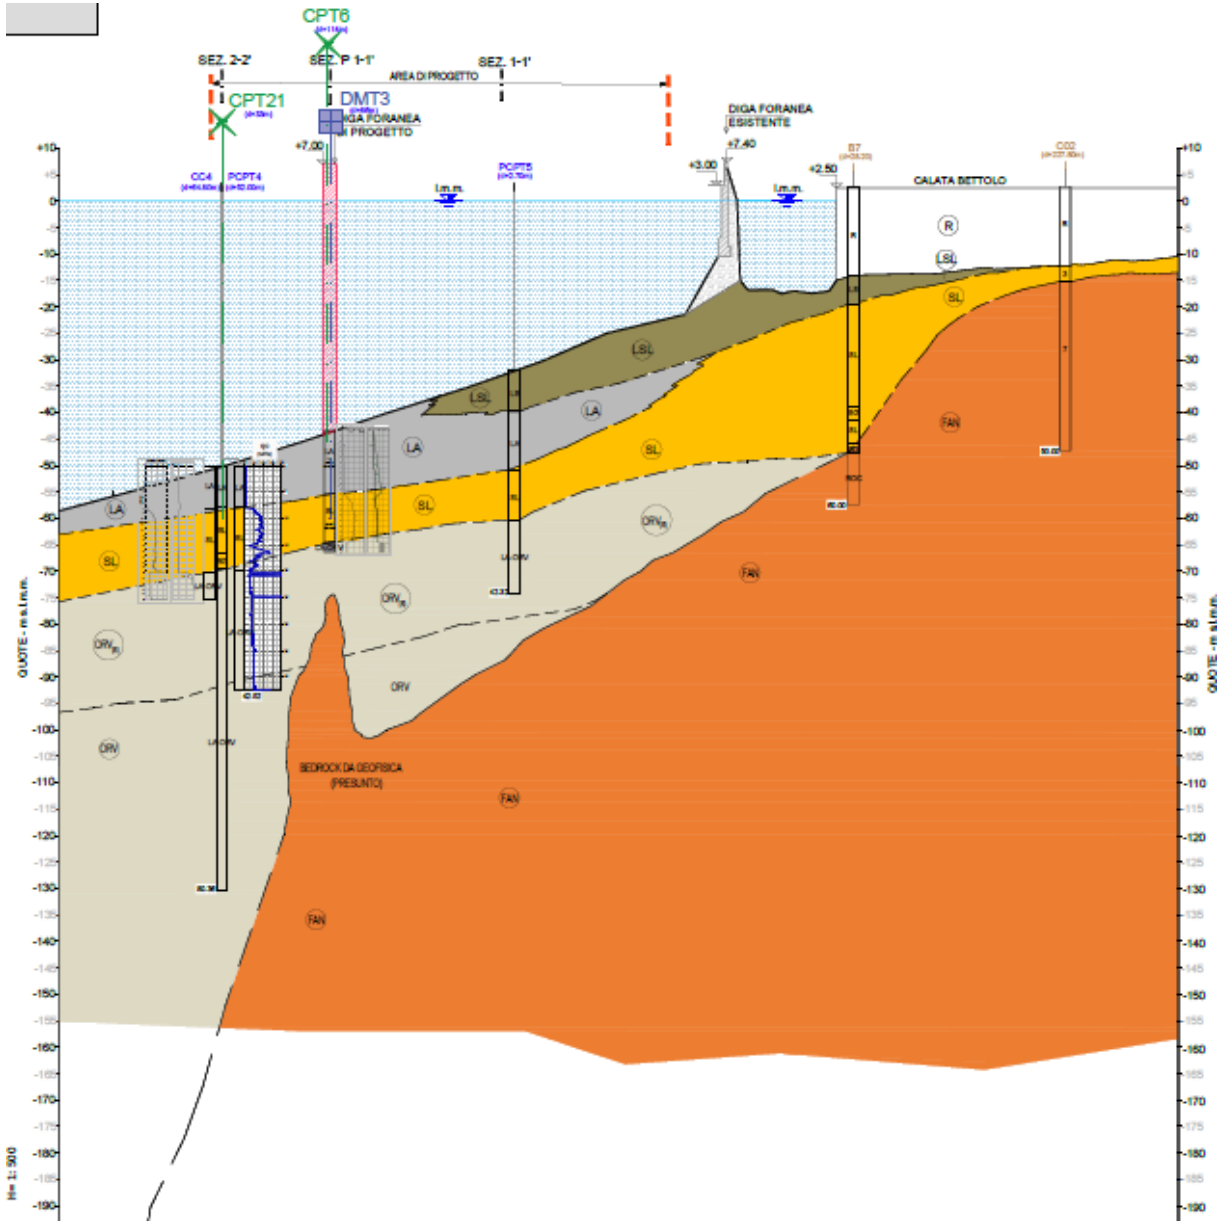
Sezione geotecnica di calcolo 5-5'
